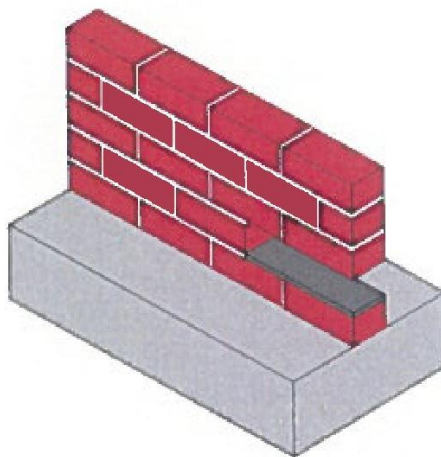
Concretização de barreiras físicas: substituição parcial de elementos de construção [9]
